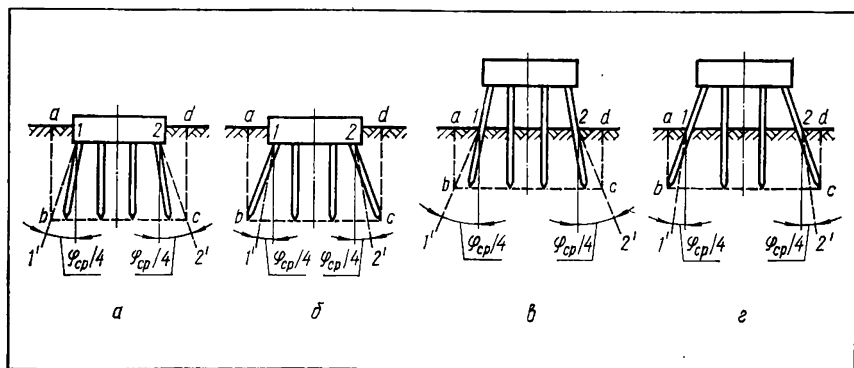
К расчету свайных фундаментов как условно-массивных:
